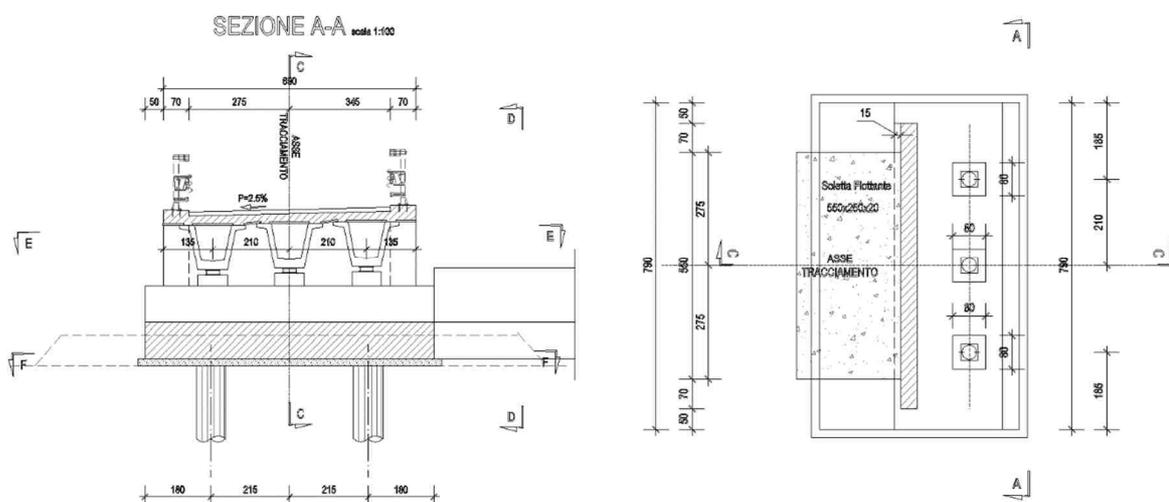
Spalla A prospetto e pianta - Ponte Rio Cungianus su viabilità S09
